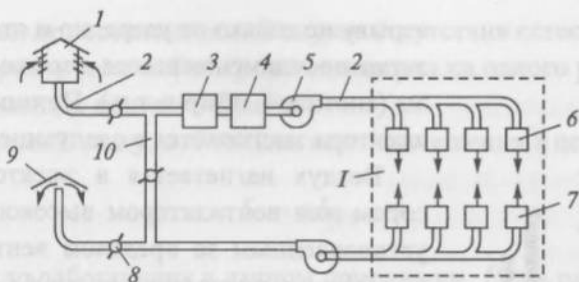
Схема приточно-вытяжной механической вентиляции:
